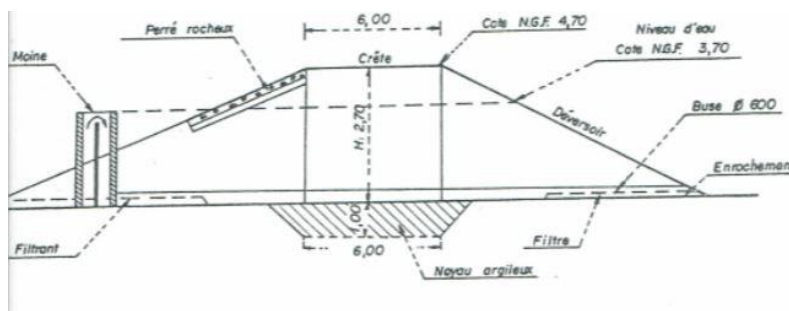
Coupe de la digue sur les plans de construction du lac (fédération de pêche 44)
